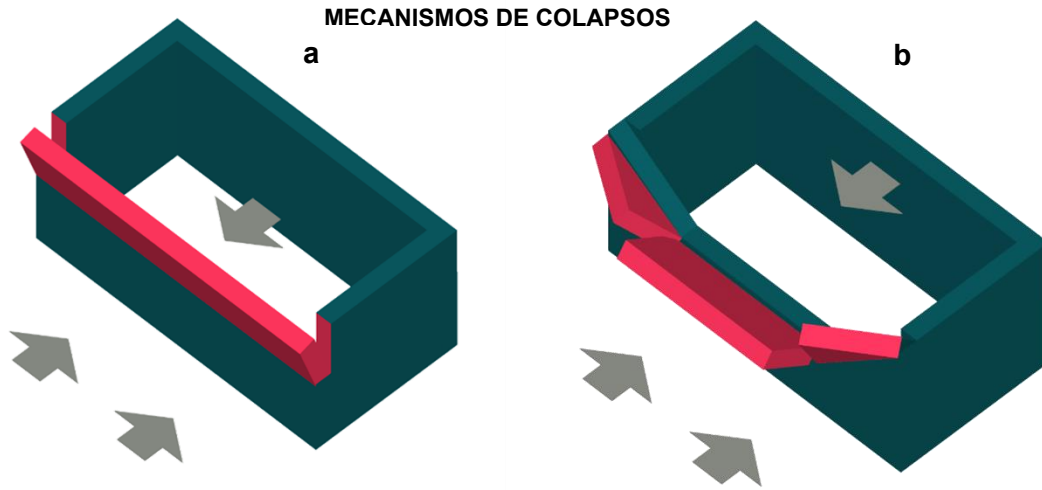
a) Colapso de muros por giro global de muros. b) Mecanismo de colapso de paredes largas fuera del plano. Fuente: Elaboración propia en base a esquemas de Paulo Lorenço.
